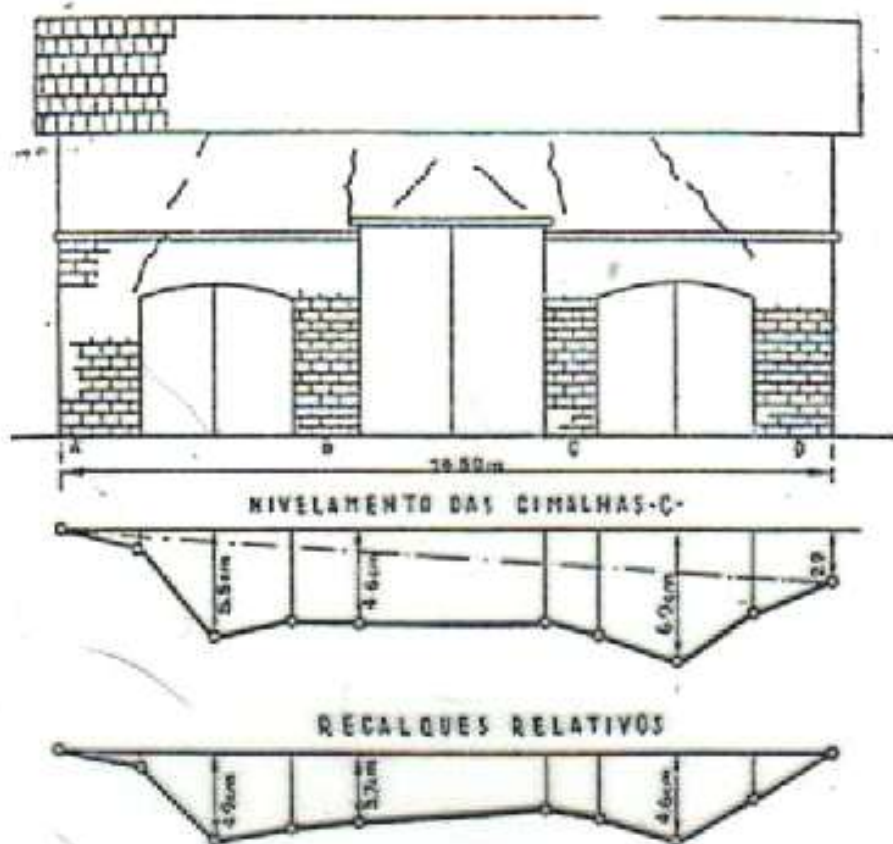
Inclinações e fissuras nas construções fundadas à superfície sobre antigos fundos de rio, encostas
